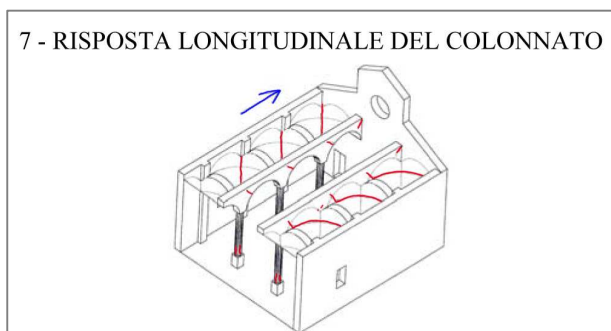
Meccanismo n°7 –risposta longitudinale del colonnato- - tratto dall'abaco dei meccanismi di collasso.
